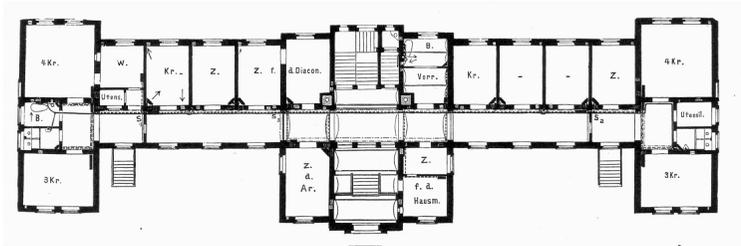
Langensalza, hôpital (1882-1883), plan du rez-de-chaussée (tiré de: DB, 1885).
